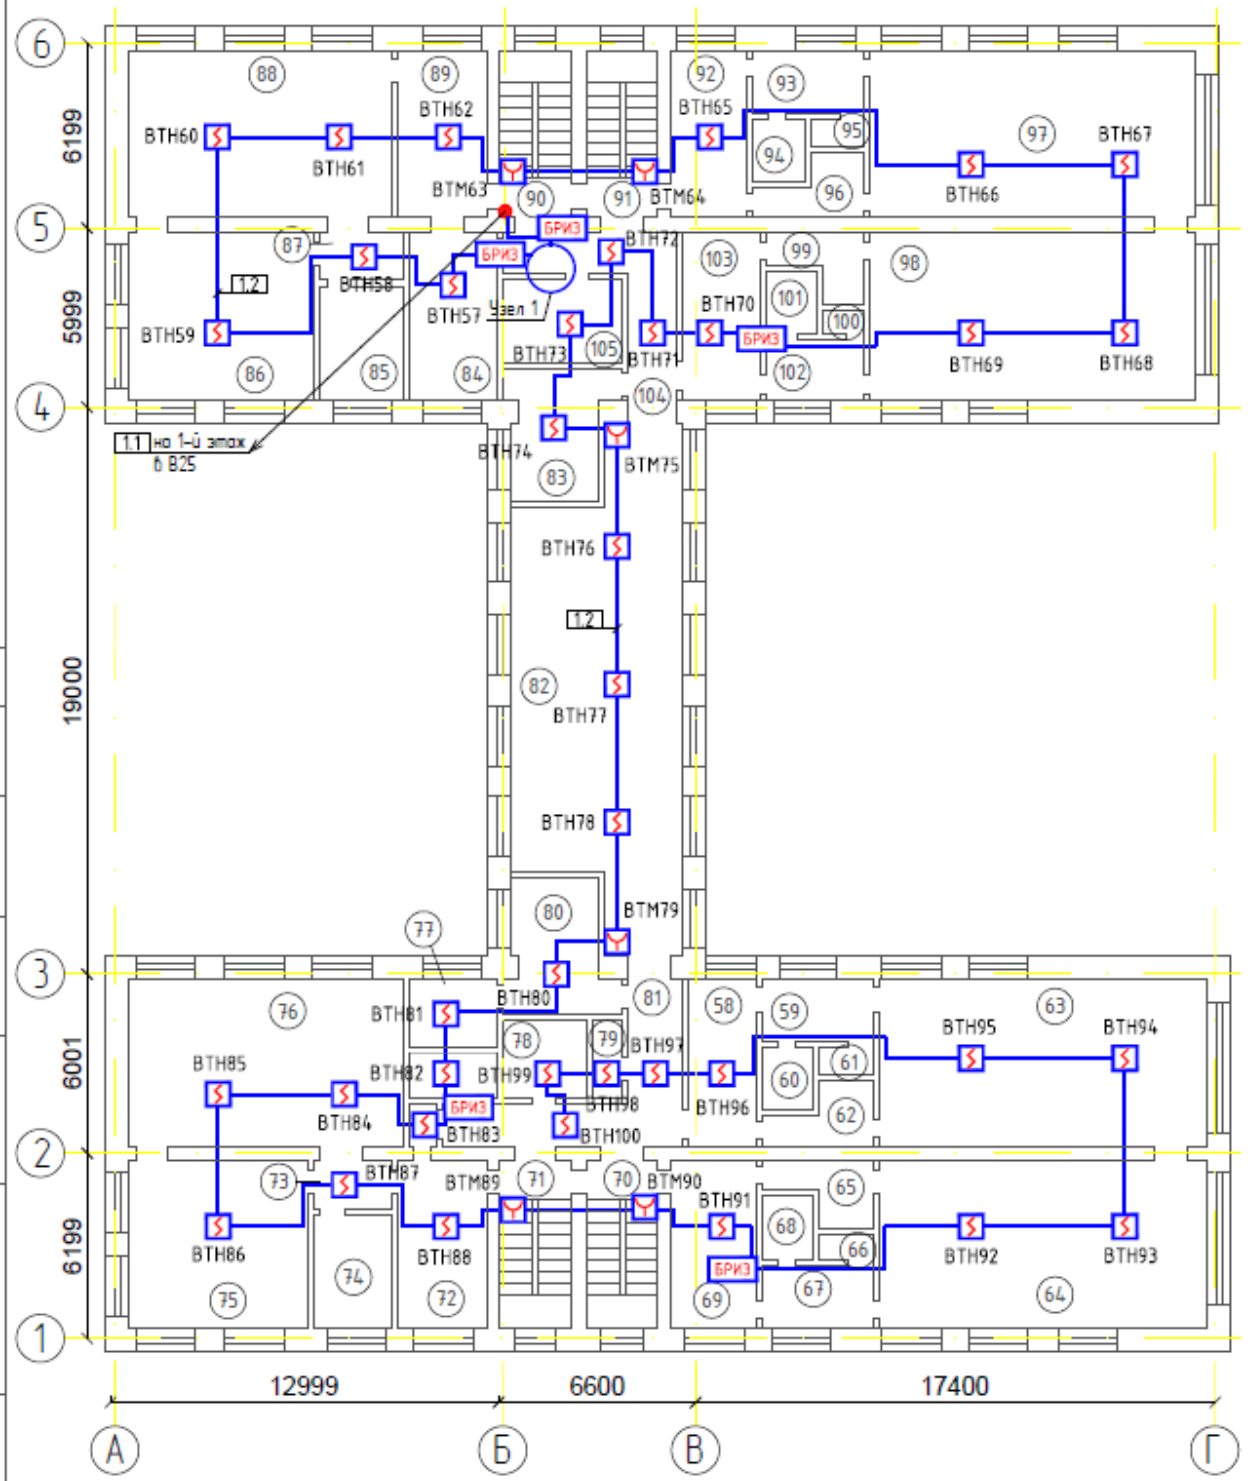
План 2-го этажа сети пожарной сигнализации
